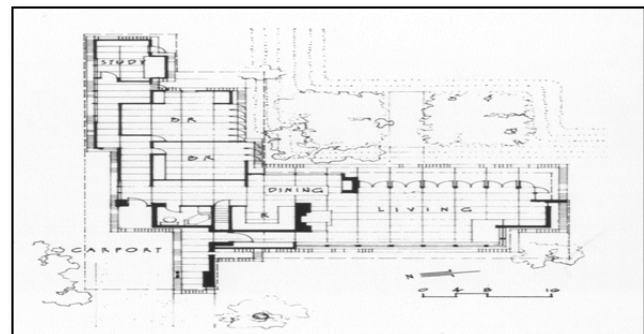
Planta Arquitectónica Casa Jacobs.
